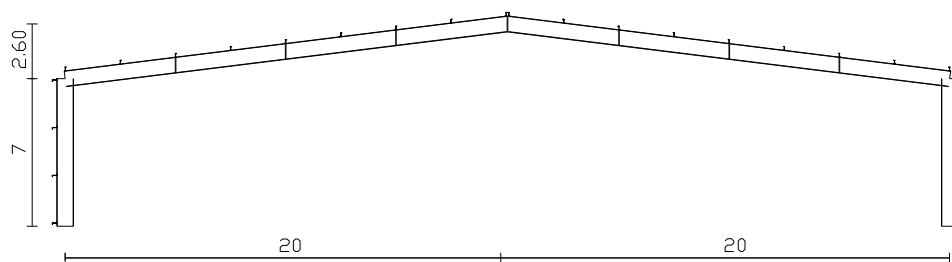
Pórtico rígido viga e pilar de alma cheia, vão de 40.00m
